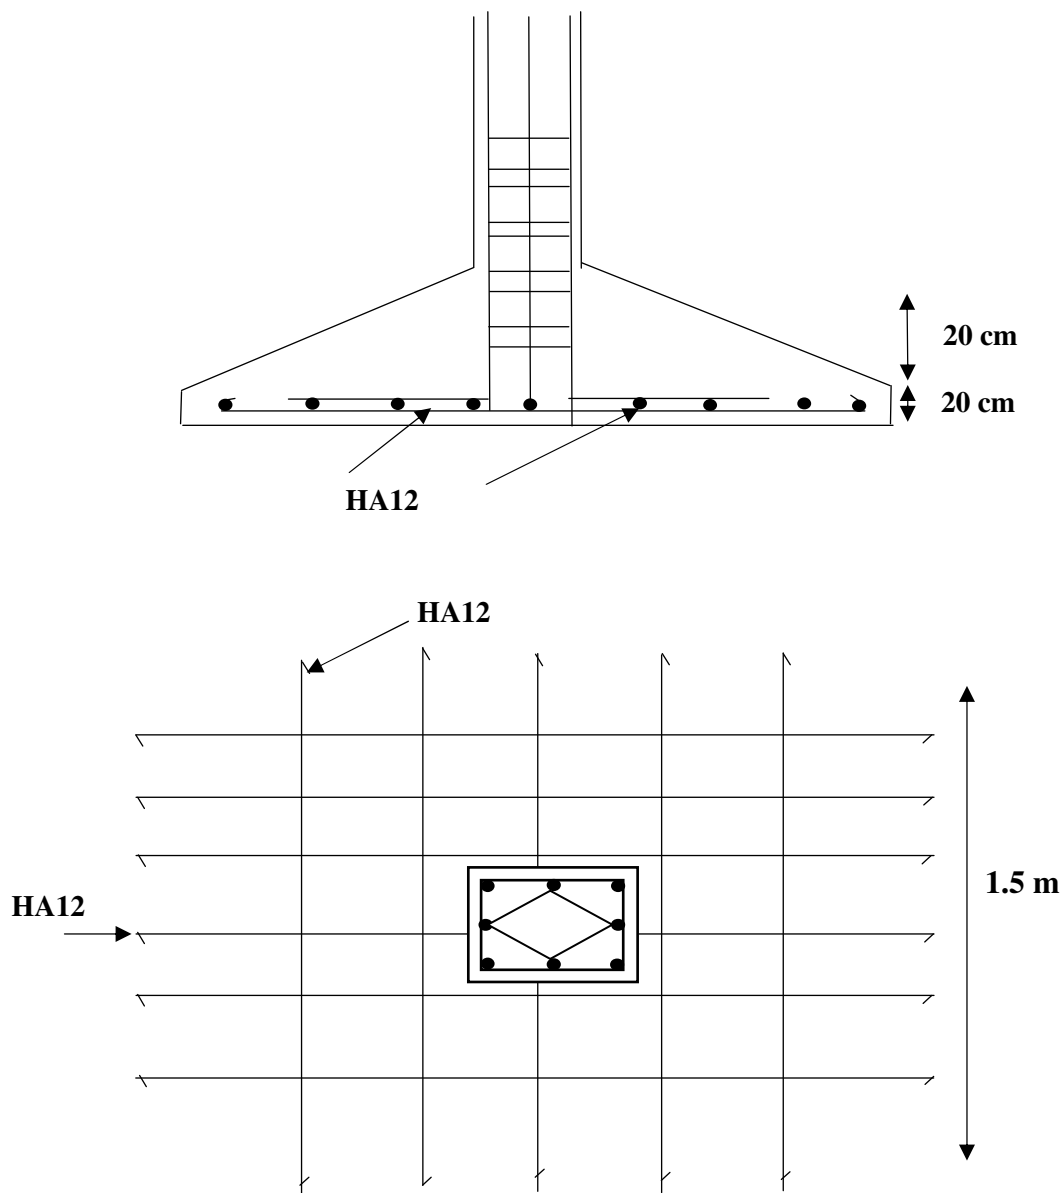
Schéma de ferrailage d'une semelle isolé sous poteaux carré.
